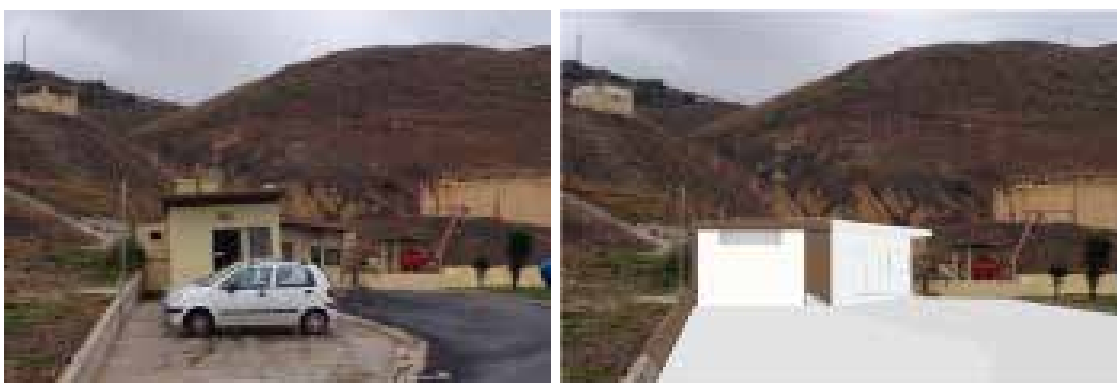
Telheiro - alçado Sul existente e proposto. (Ilustração nossa, 2017).
